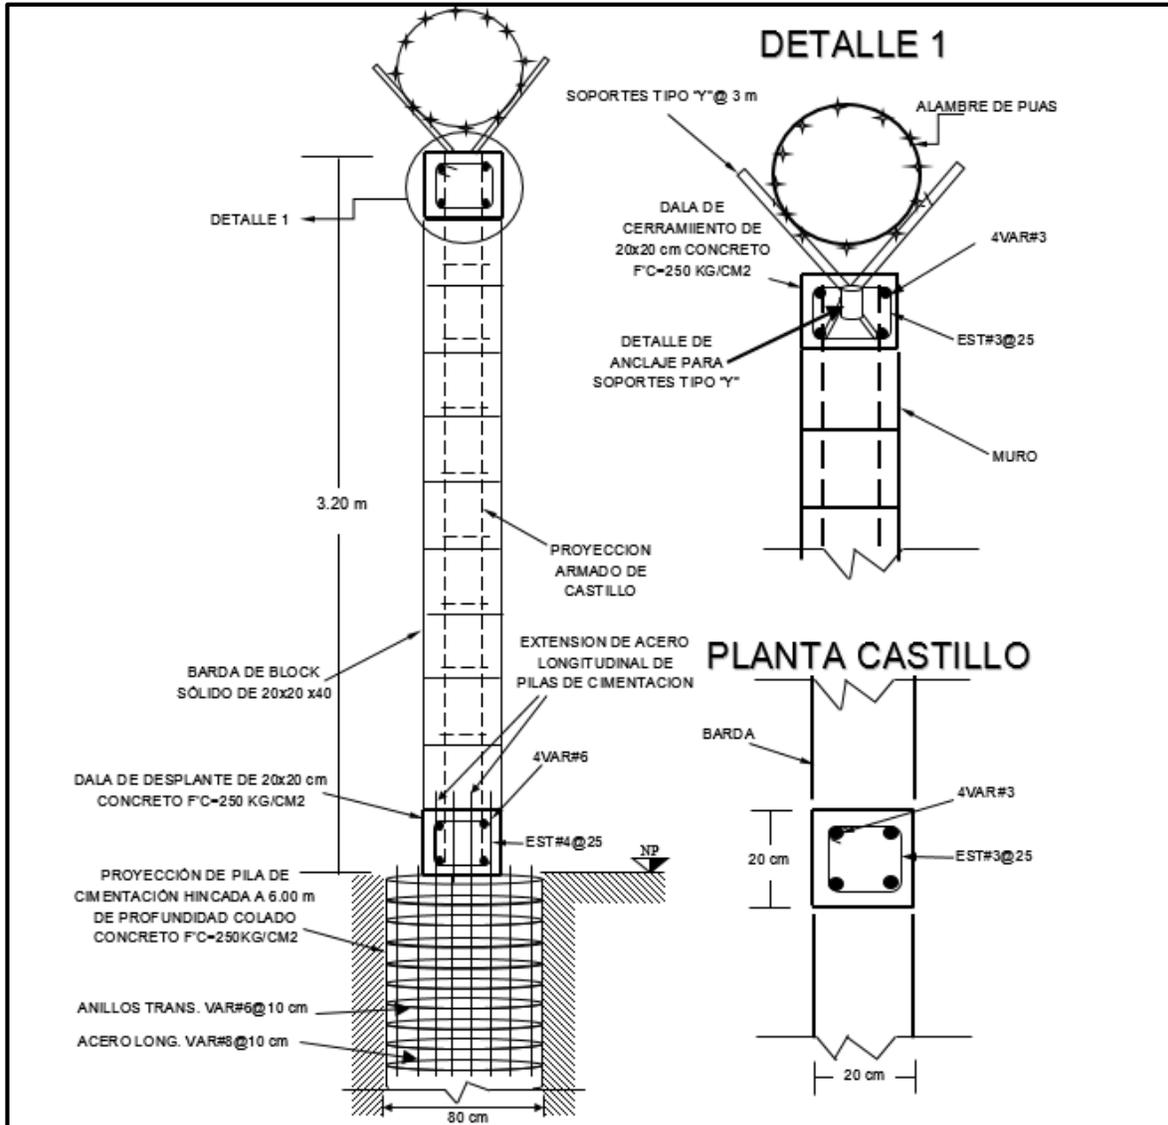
Disposición y armado de la dala de desplante para el muro de la Barda Perimetral
